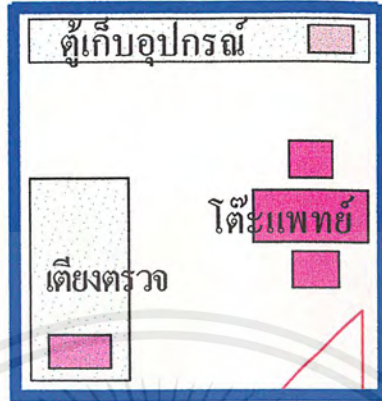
แสดงการจัด Planing แผนกกุมารเวช
